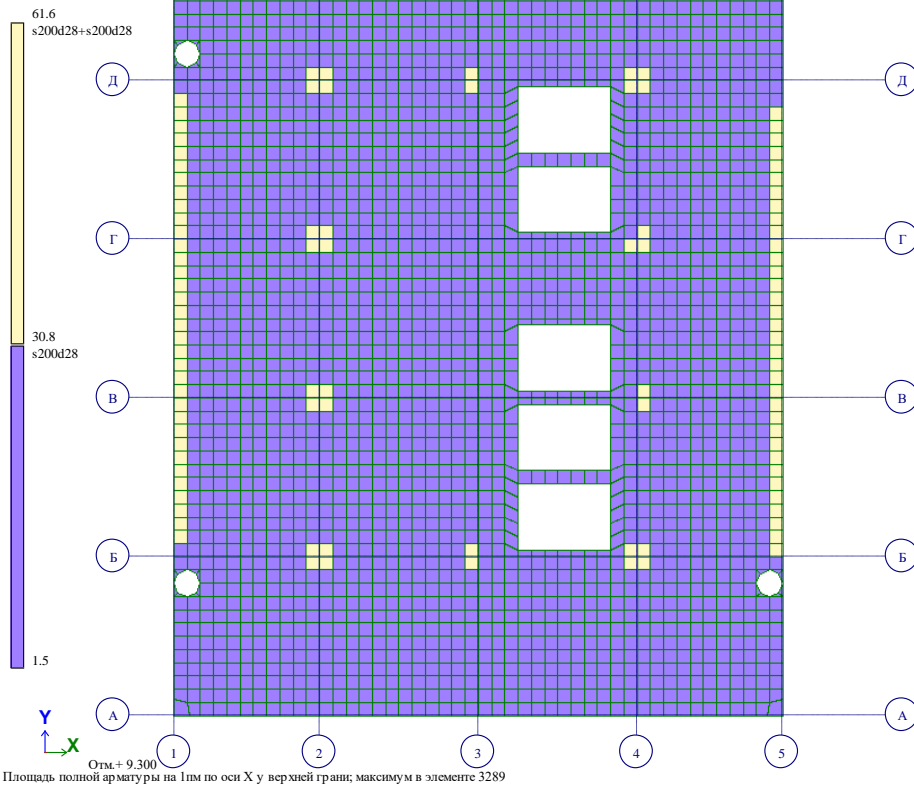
Изополя армирования (плиты перекрытия на отм. +0,000) - верхняя арматура по X
